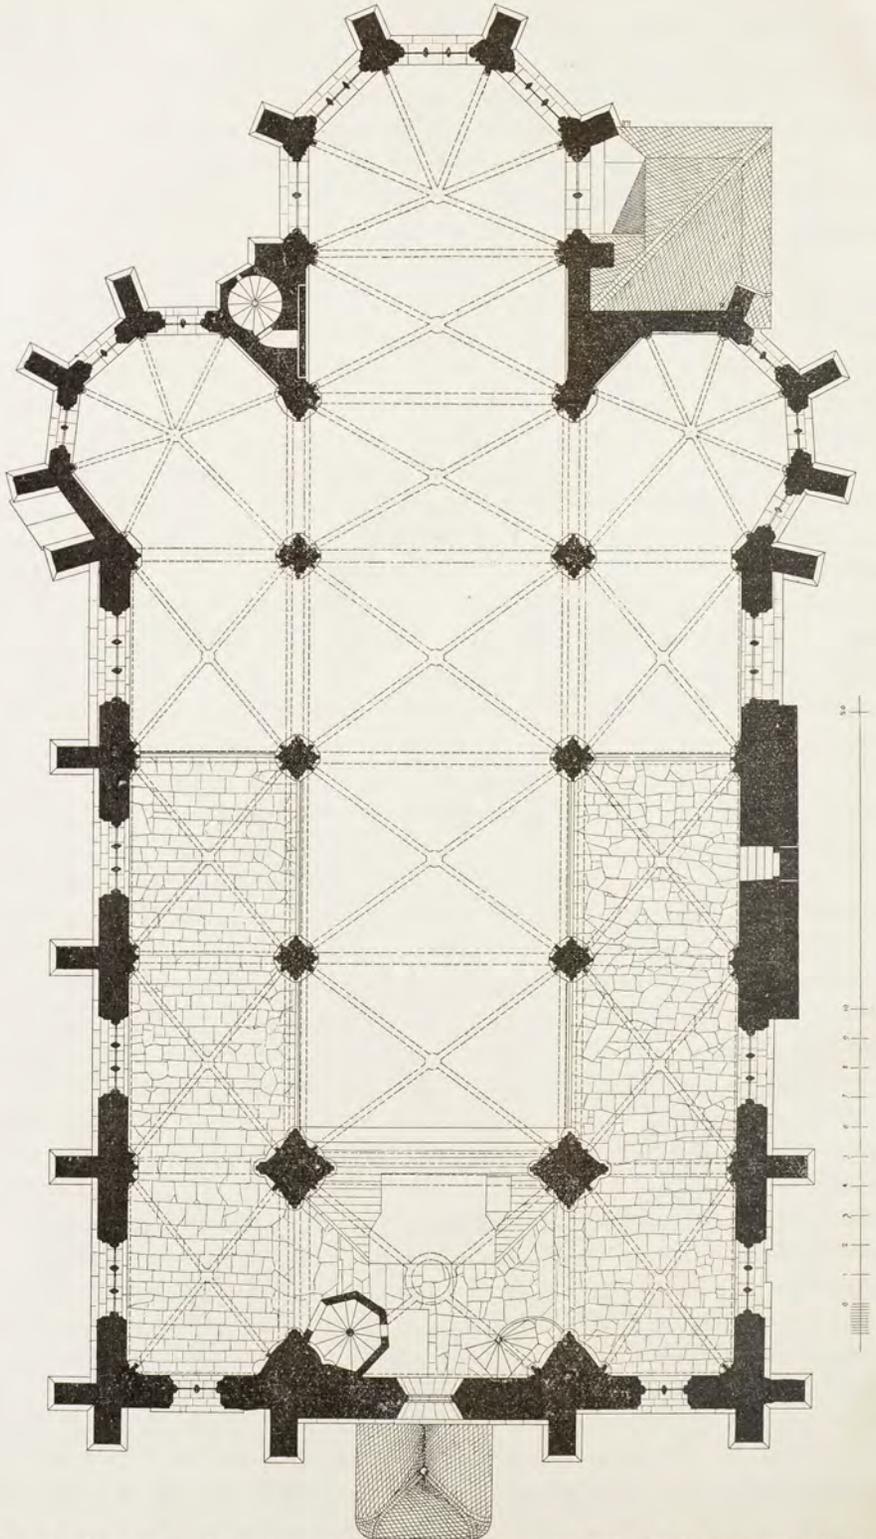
Ahrweiler. Grundriss der kathol. Pfarrkirche vor der Wiederherstellung.
